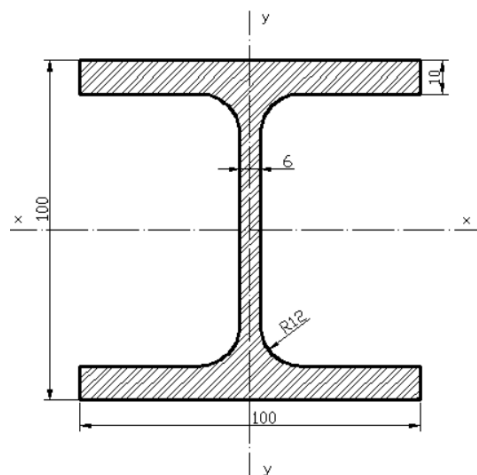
Perfil HEB 100 utilizado para los pisones, cotas en milímetros
